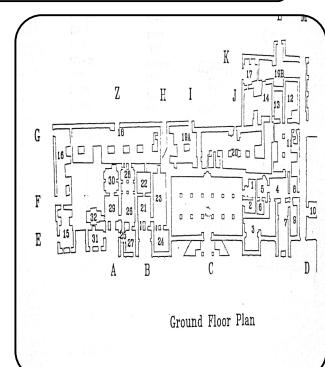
مسقّط فقي للدور الأرضي لمصنع الكسوة
